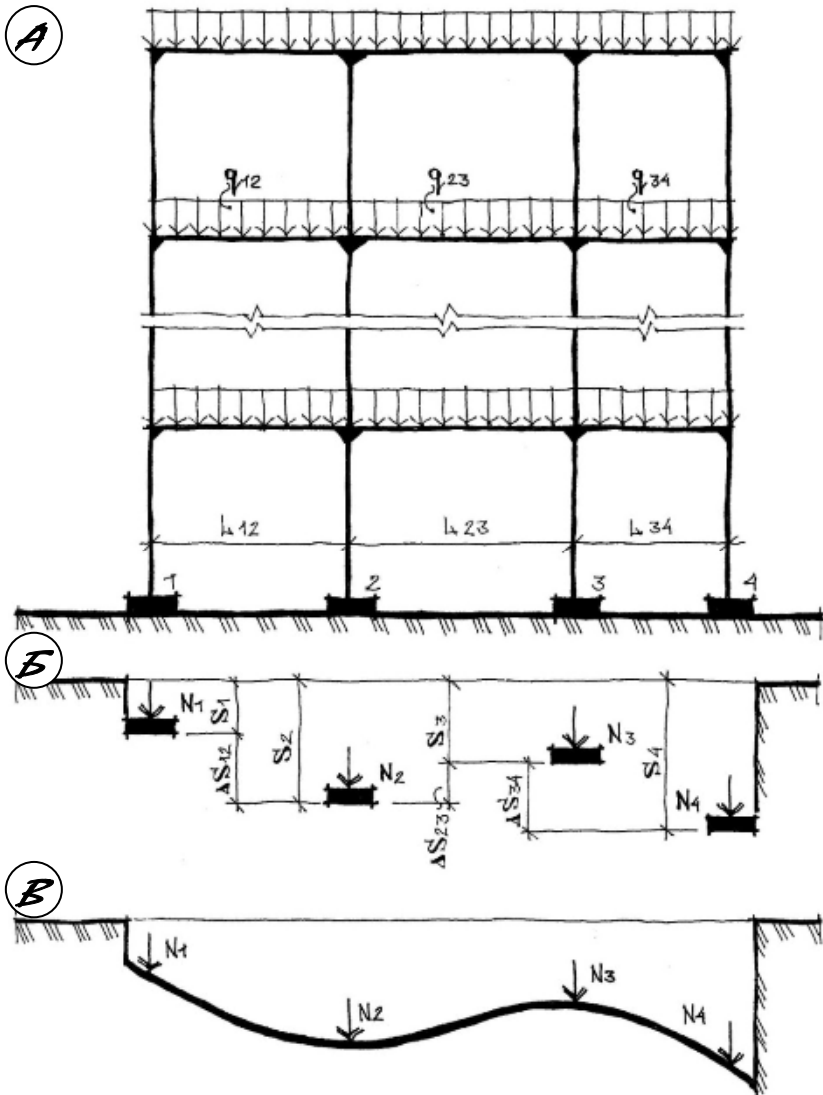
Осідання фундаментів каркасної будівлі: а – розрахункова схема каркасу; б – осідання і різниці осідань окремих фундаментів; в – осідання стрічкового фундаменту
